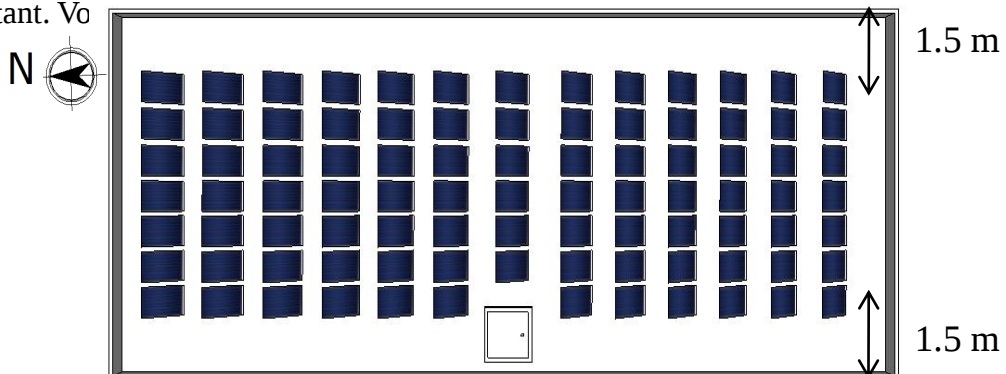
Plan terrasse du bâtiment avec l'installation des capteurs solaires (source: auteur)
